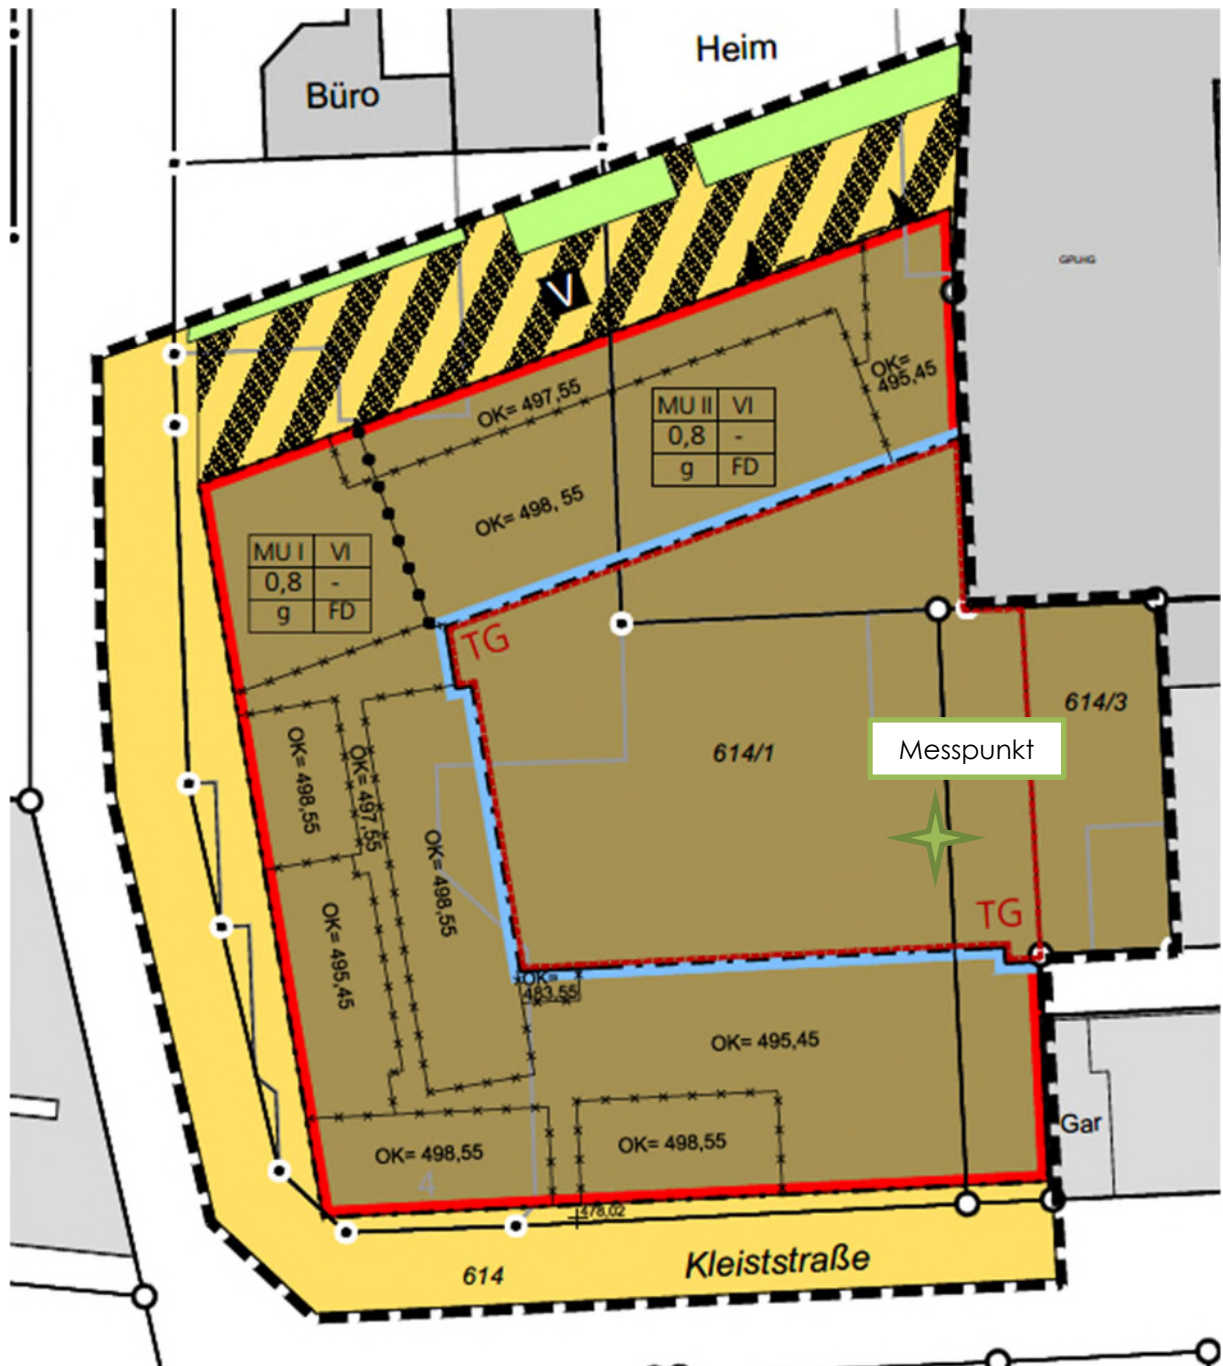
Ausschnitt aus dem Bebauungsplan ‚Nördliches Dichterviertel – Teil III Kleiststraße‘ mit Lage des Messpunktes
